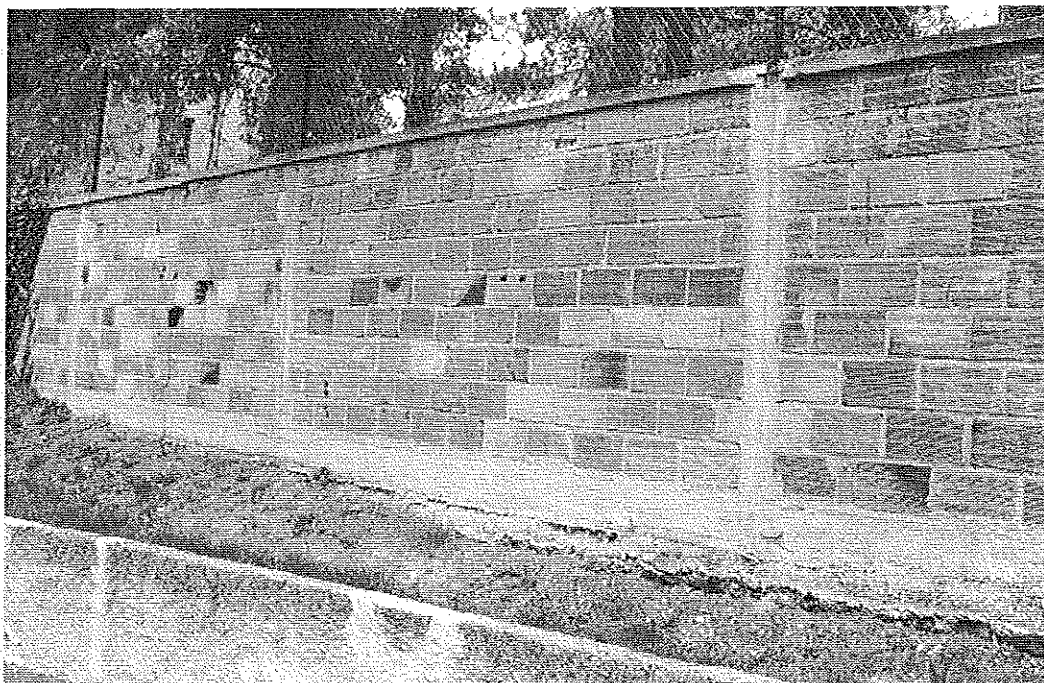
Partie amont du mur de clôture. Partie basse et semelle déchaussée côté propriété voisine.
